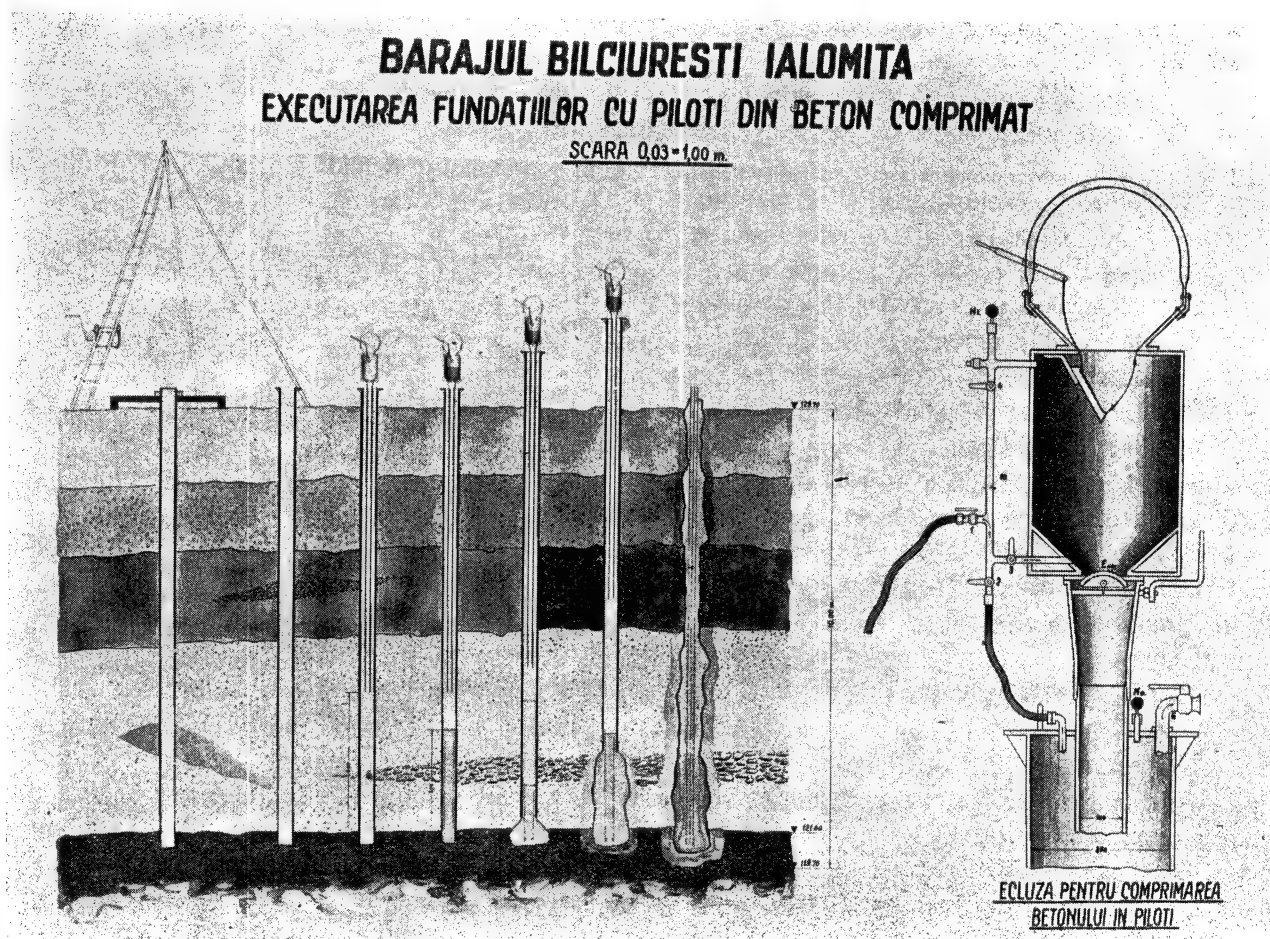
Barajul Bilciurești-Ialomita. — Fazele executării piloților de beton armat după metoda injecțiunilor.
